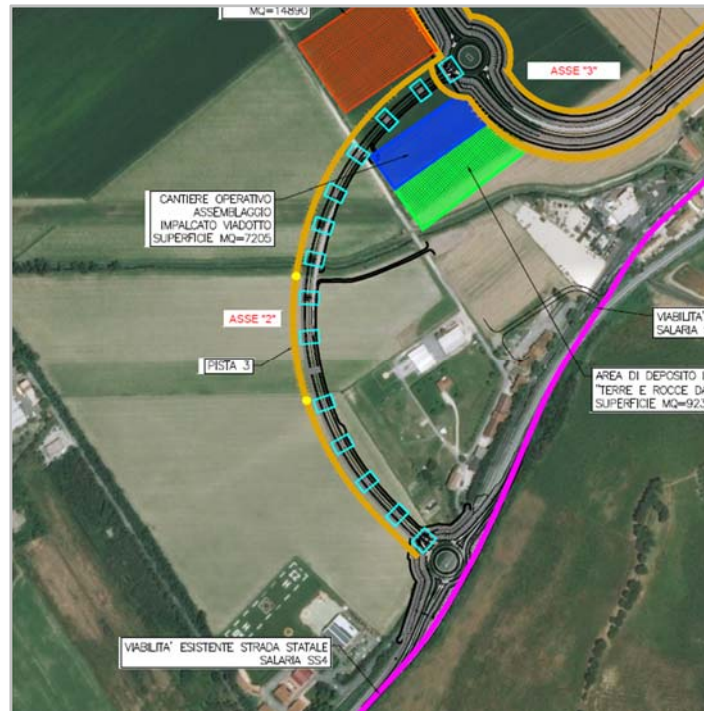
Dettaglio di progetto dell'Asse 2 "Viadotto Pantanella", tra la Rotatoria B e la Rotatoria C.
